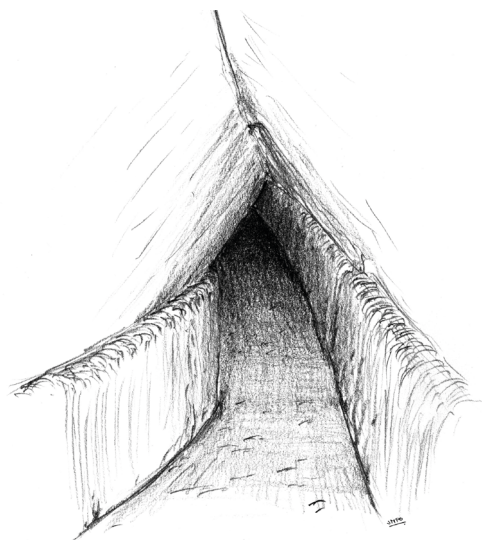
Canal del acueducto de Kition del periodo persa (448 a 332 a. C.) con techo apuntado.
